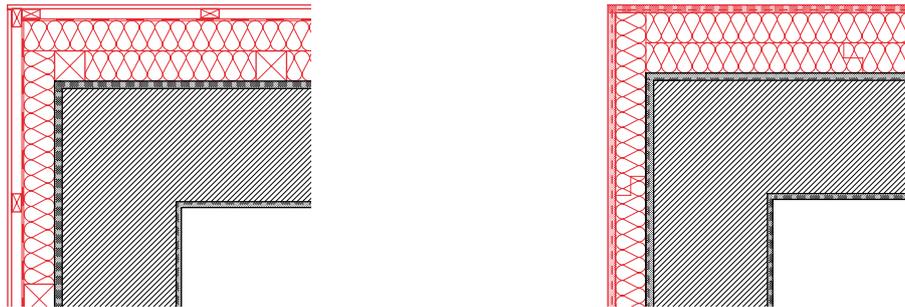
Konstruktionsprinzip Lösungsansatz b) Außendämmung mit geringerer Dämmstärke; links: vorgehängte hinterlüftete Fassade, rechts: Wärmedämmverbundsystem
